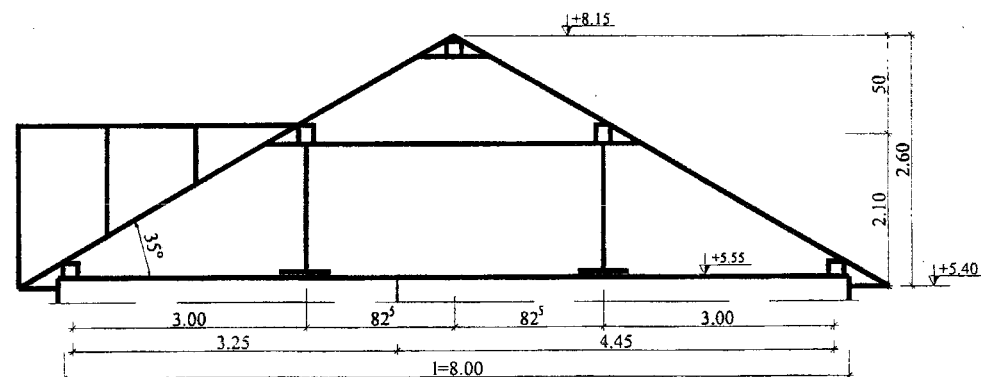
Secțiune transversală prin șarpantă – schemă de calcul
